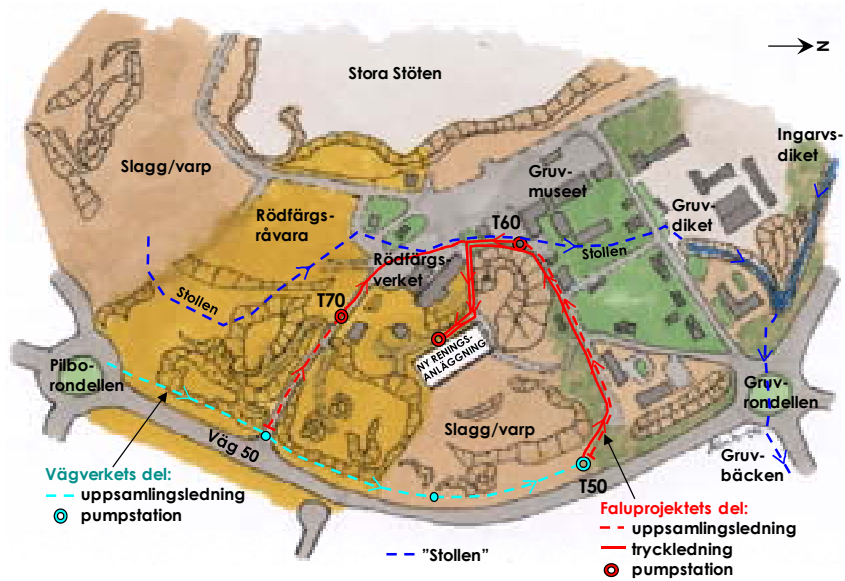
Plan över Pilbodräneringens gamla och nya sträckning (gröna linjer).
